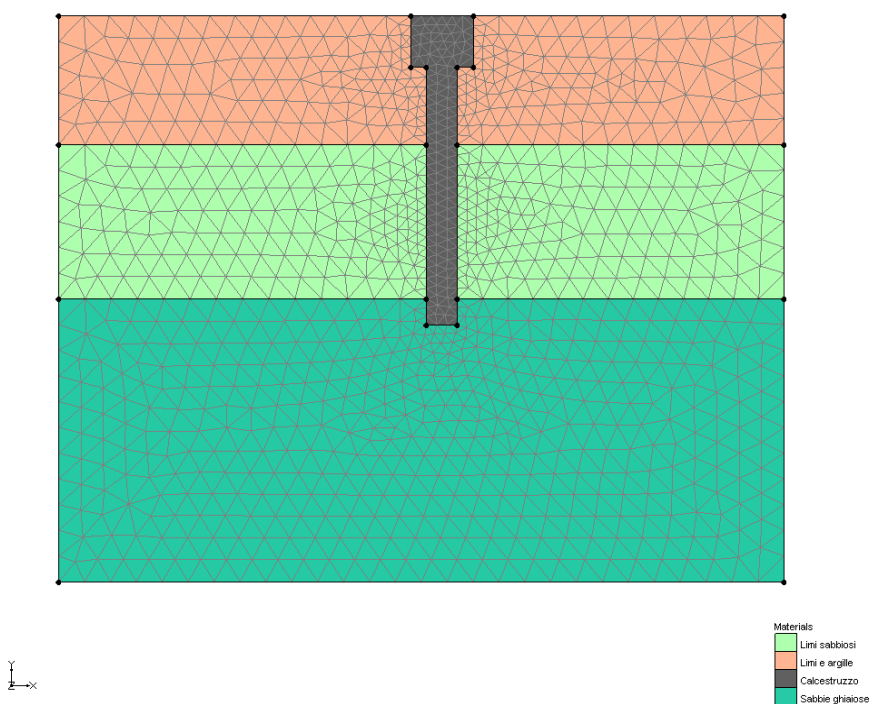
Schematizzazione geometrica della sezione di progetto tipo C
